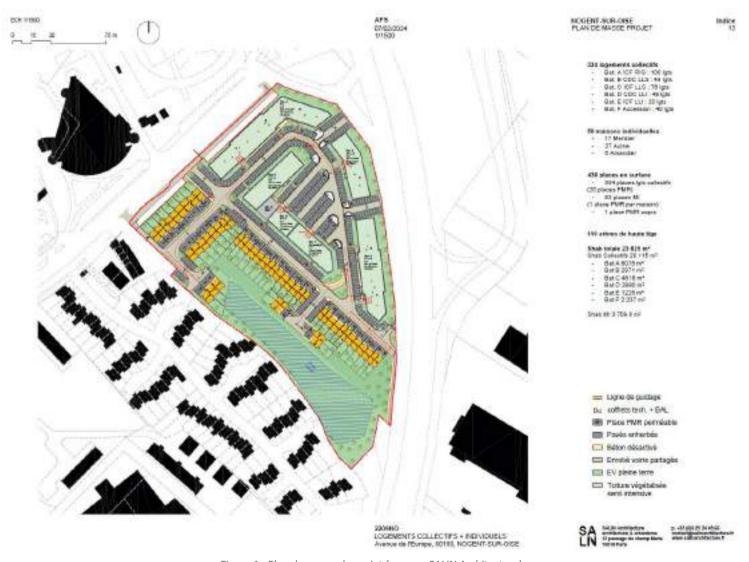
Plan de masse du projet (source : SALIN Architecture)
